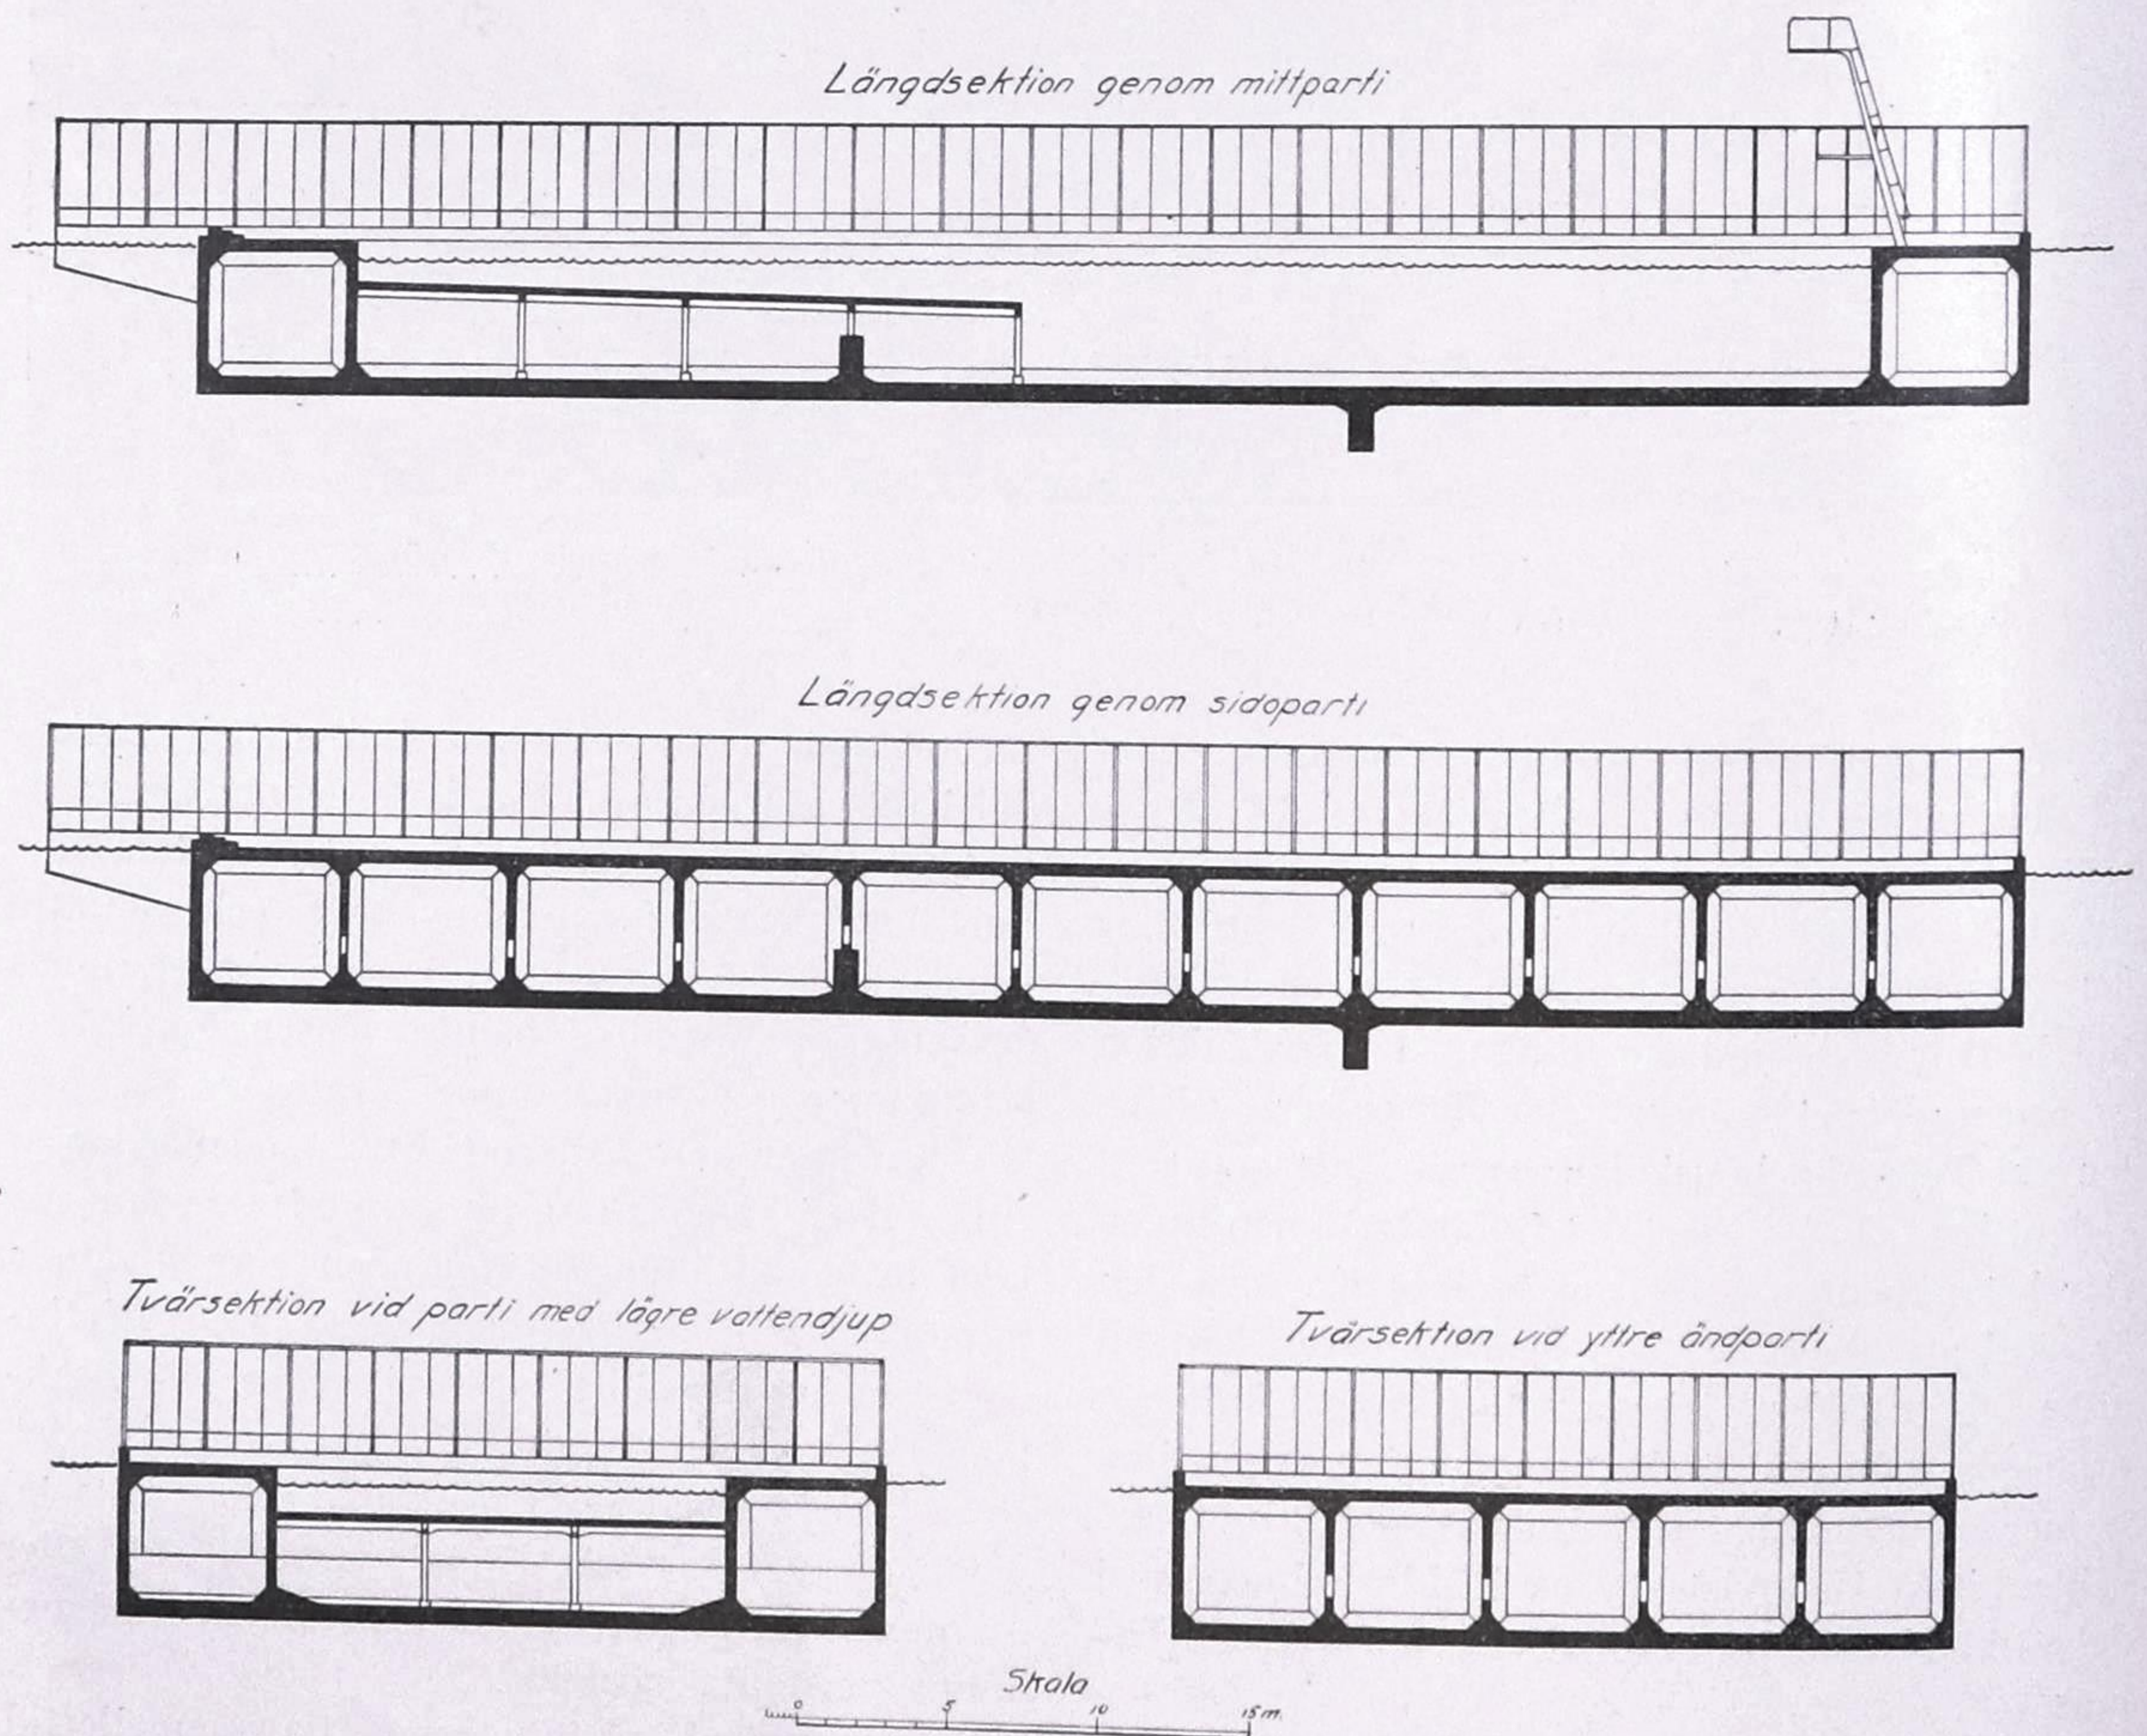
Längd- och tvärsektioner av betongpontonen, som bildar den flytande delen av badet, med bassängen och utrymmena för renings- och pumpanläggningen.
